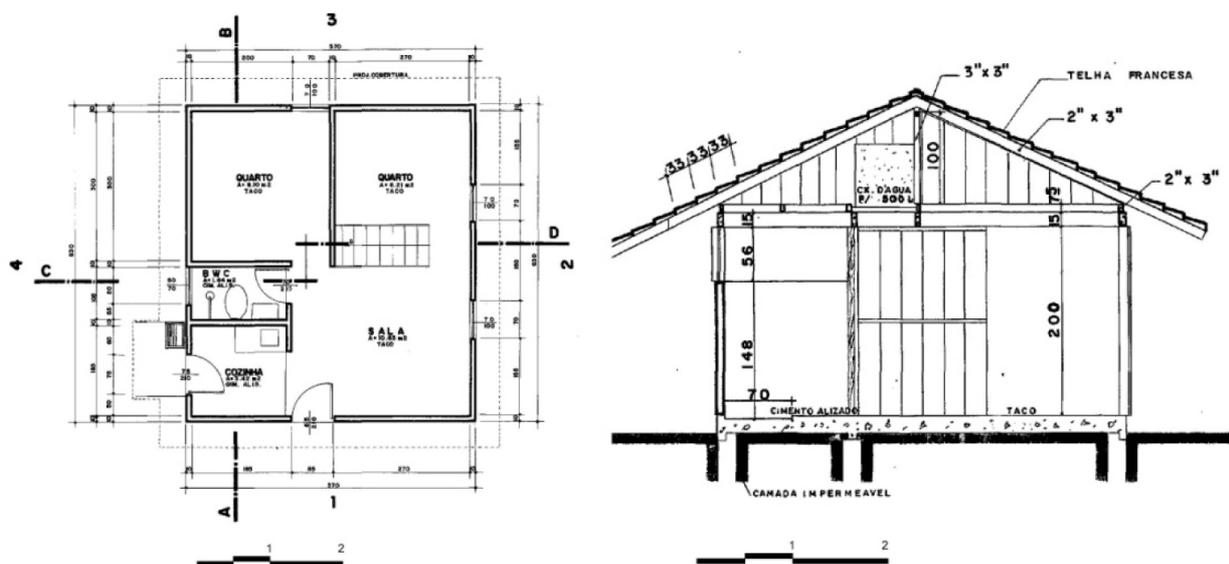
Planta e corte transversal da tipologia de casa CT-1-21, adotada para o Conjunto Habitacional Vila Nossa Senhora da Luz.
